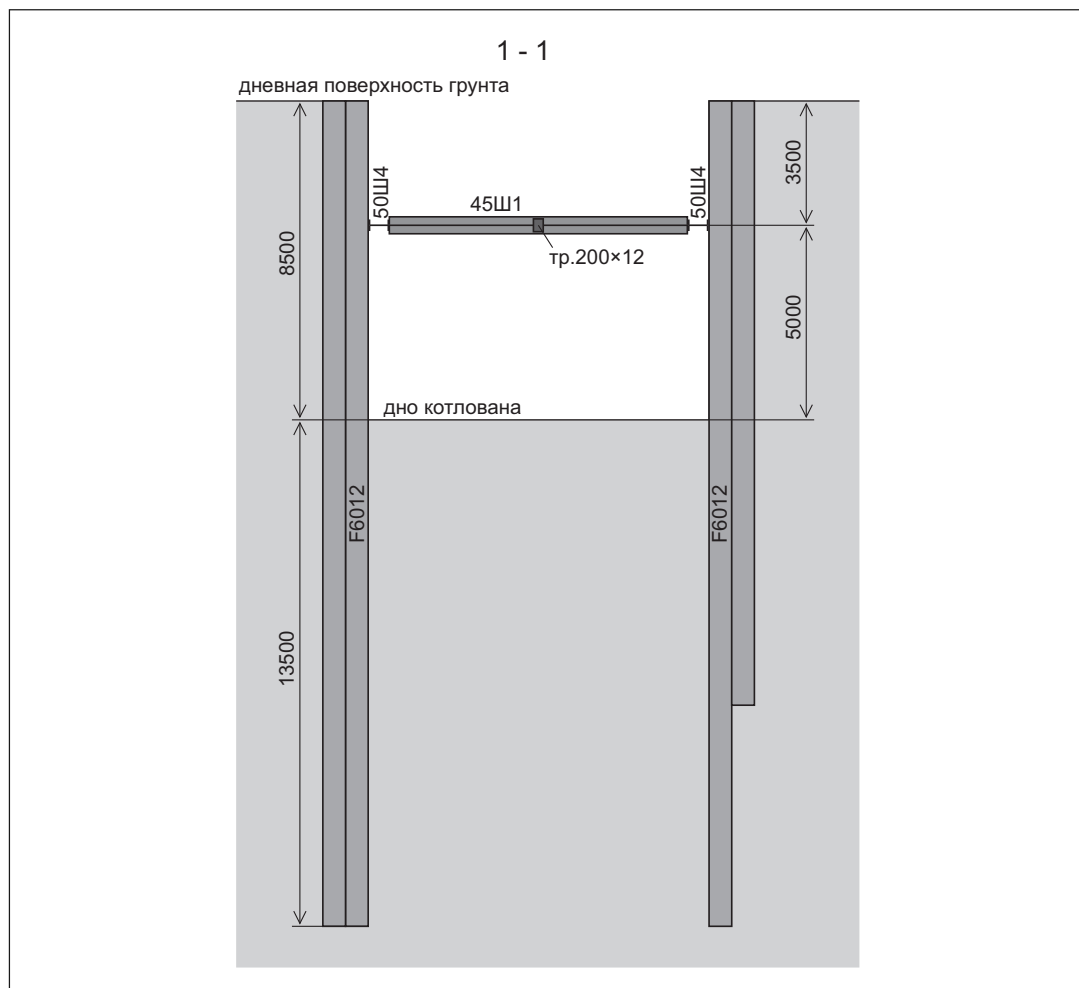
Поперечный разрез котлована на опытной площадке
